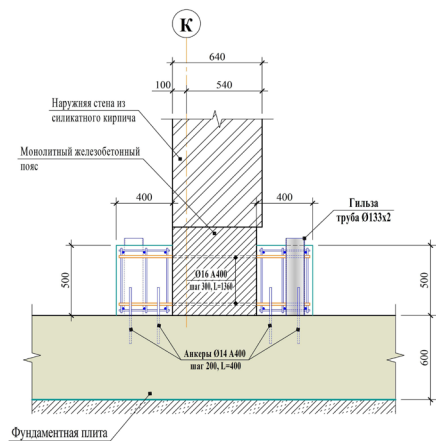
Усиление фундаментной плиты железобетонными балками вдоль наружной продольной стены по оси К на участке в осях 3-4 (см. рис. 3 цв. вклейки)
